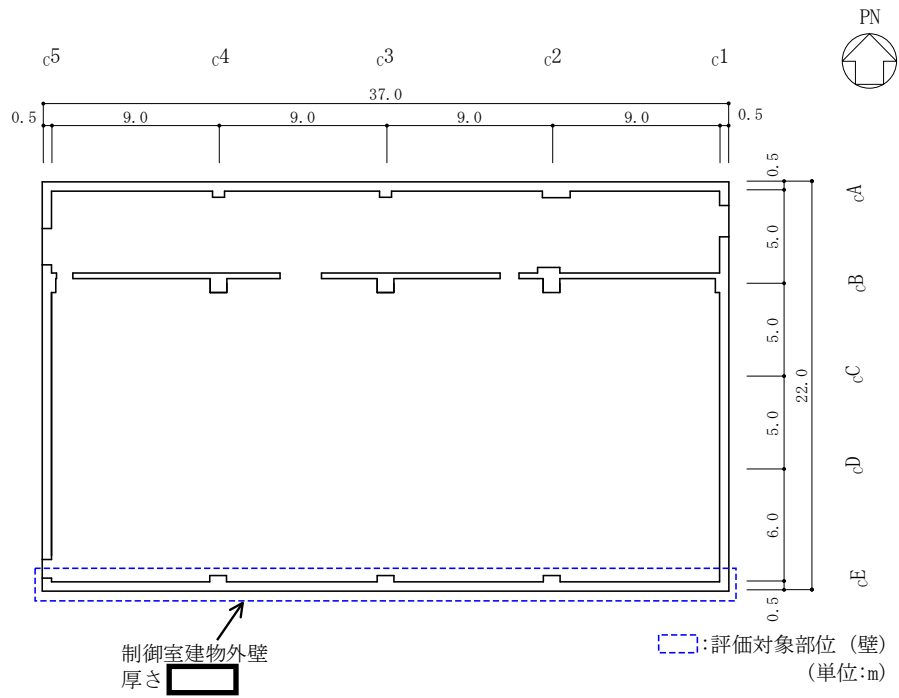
(1) 制御室建物の概略平面図 (EL 16.9m)
